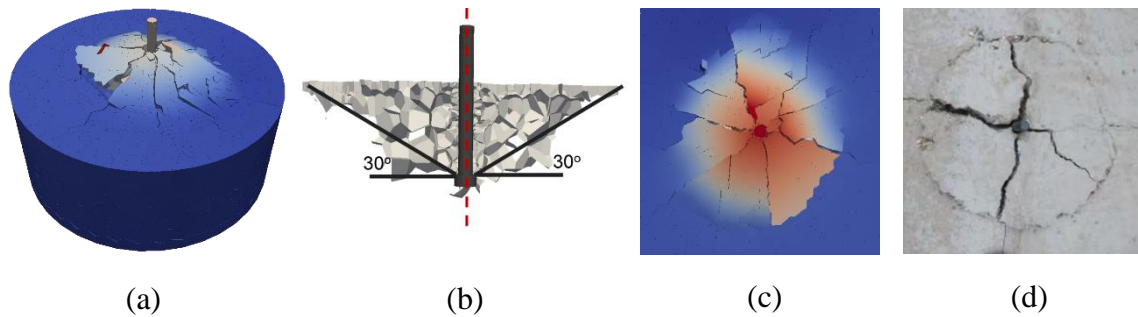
(a) Champs de déplacement du béton, (b) Cône de béton, Fissures radiales (b) DEAP, (c) Essai
